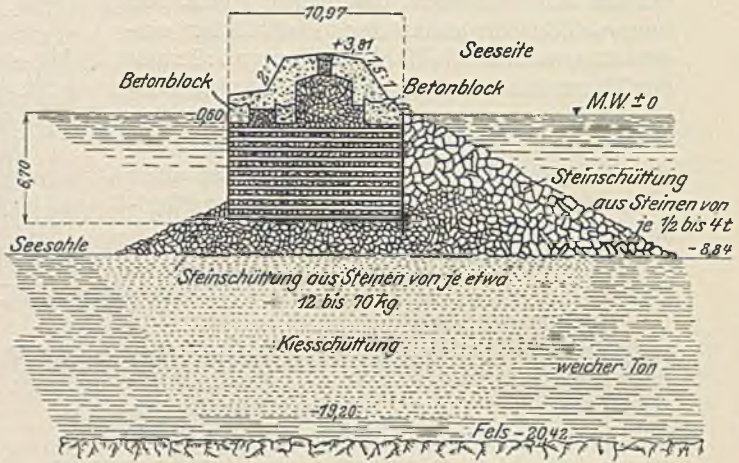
Gründung einer Mole auf einer Steinkiste nach vorhergehender Verdichtung des Baugrundes durch eine Kies- und Steinschüttung in Buffalo, N. A.
